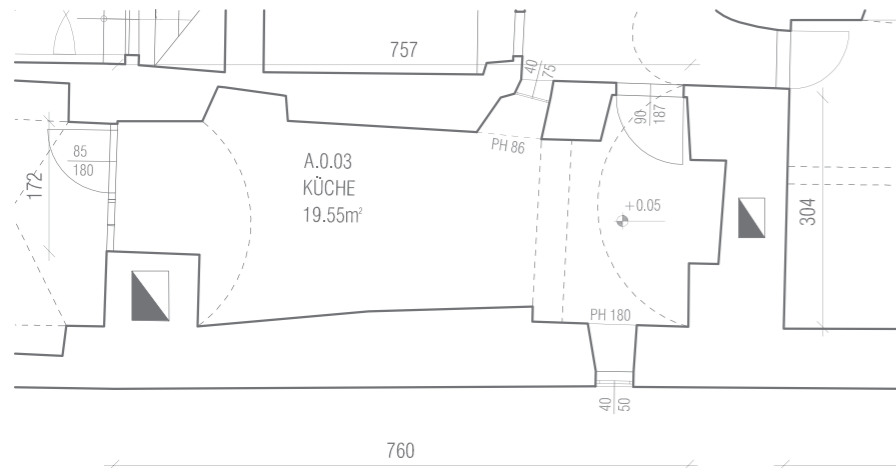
Grundriss Raum A.0.03_1:100
